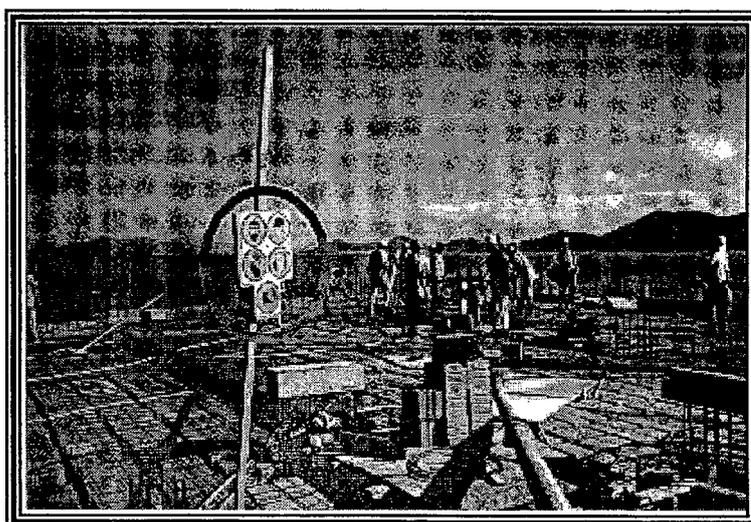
Foto sinalização EPI para pavimento executando concretagem
